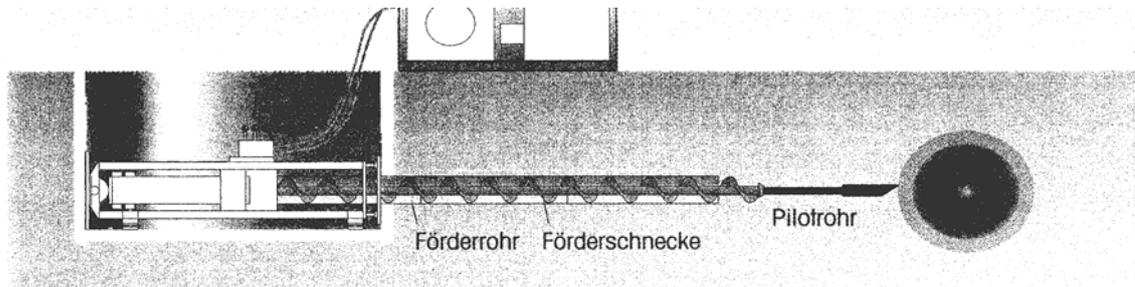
Pressbohren von Förderrohr und Schnecke am Pilotrohr geführt [1]
